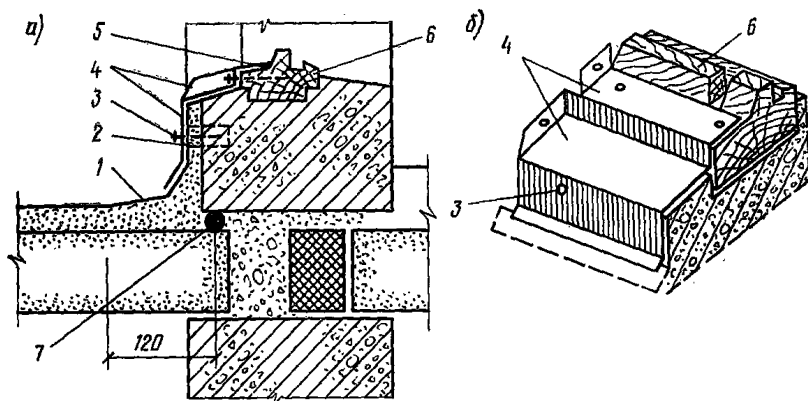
Гидроизоляция балкона при ремонте домов серии 1-464
